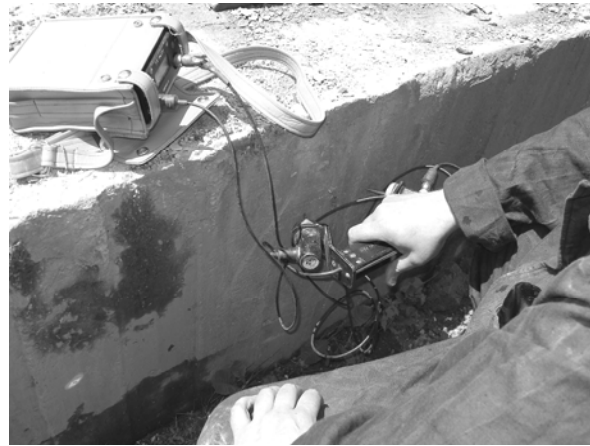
Зондування бетону фундаменту ультразвуковим імпульсним методом на його боковій грані 1 (рис. 3)
